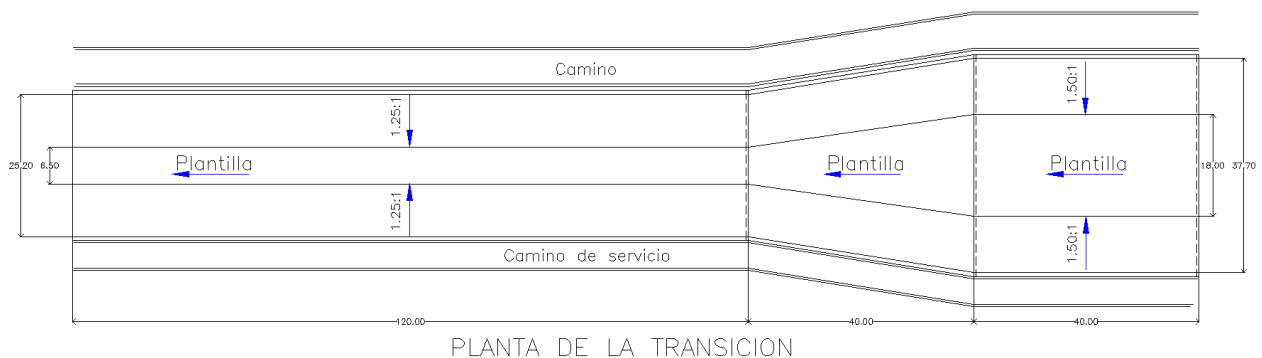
Construcción de estructura de transición a base de concreto armado.
